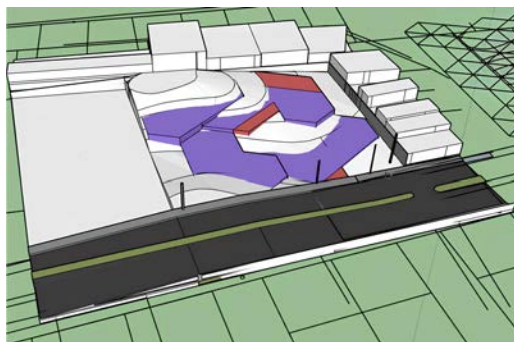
Gasto de superficie en planta baja, y revisión contra los desniveles topográficos del proyecto de edificio de departamentos
